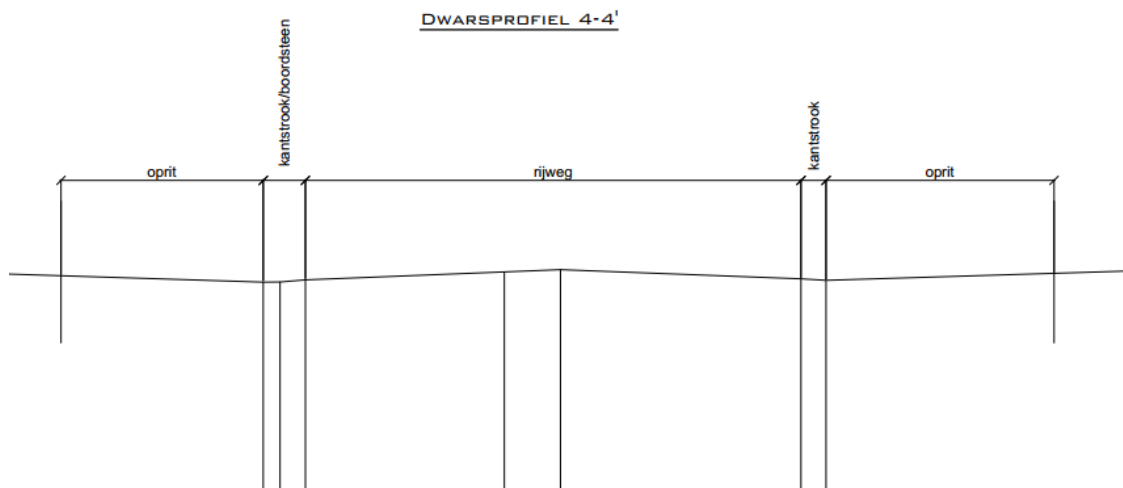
Uitsnede uit doorsnedeplan met ontworpen toestand ter hoogte van Industriepark-West parallel aan de E17
